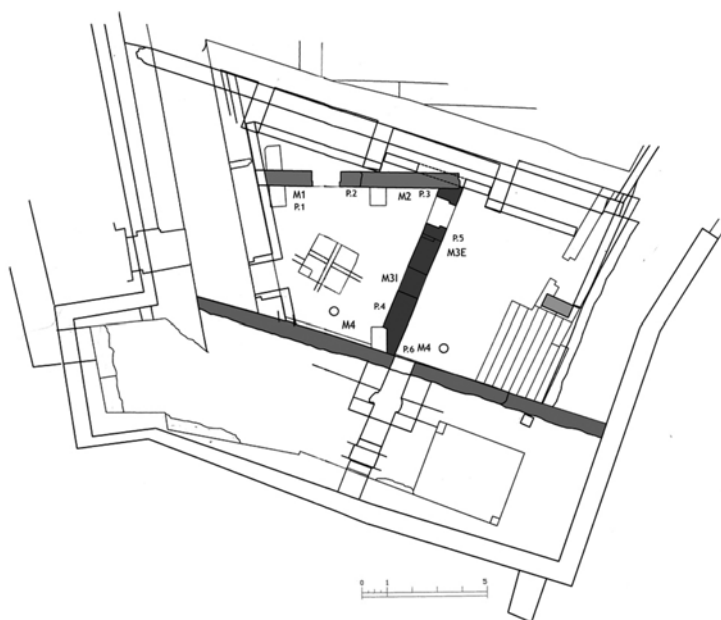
Planta de la excavación con la situación de los grafitos (Almagro y Orihuela 2006).
